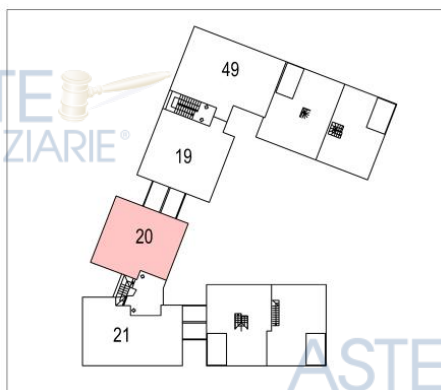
Individuazione della collocazione del subalterno 20 sulla planimetria del piano secondo del condominio
